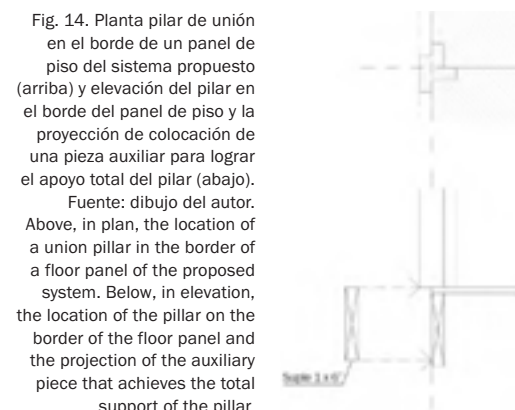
Planta pilar de unión en el borde de un panel de piso del sistema propuesto (arriba) y elevación del pilar en el borde del panel de piso y la proyección de colocación de una pieza auxiliar para lograr el apoyo total del pilar (abajo).
